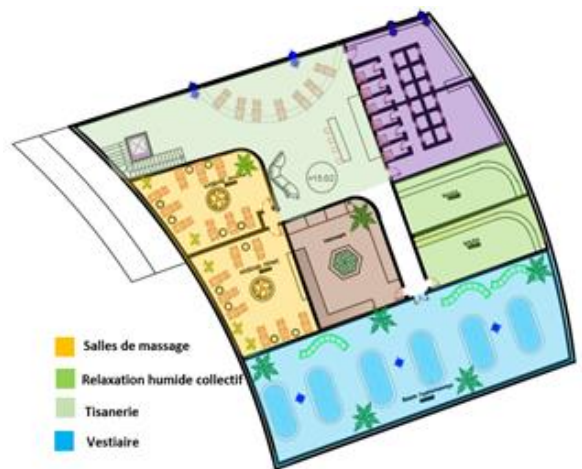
vue en plan sur l'entité bien être (niveau +19.36)
